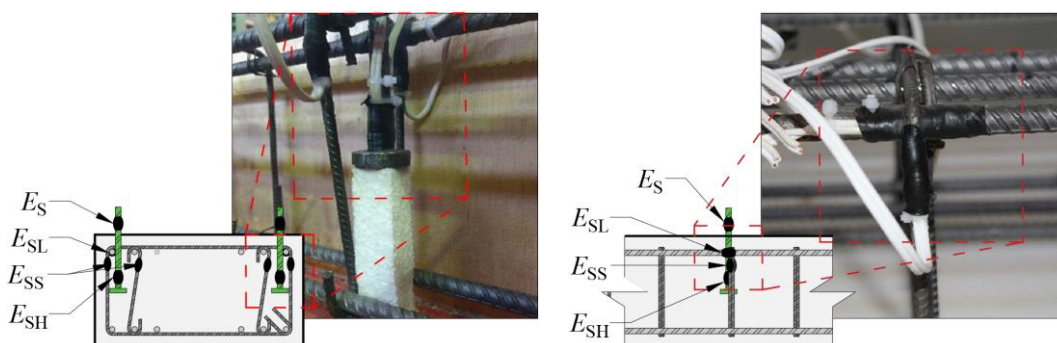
Disposição dos extensômetros nos conectores e armaduras
